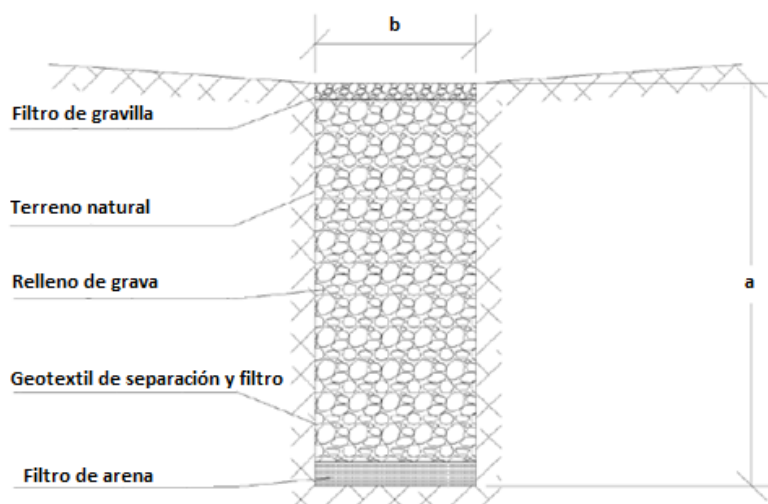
Sección tipo zanja filtrante proyectada (Fuente: elaboración propia)
